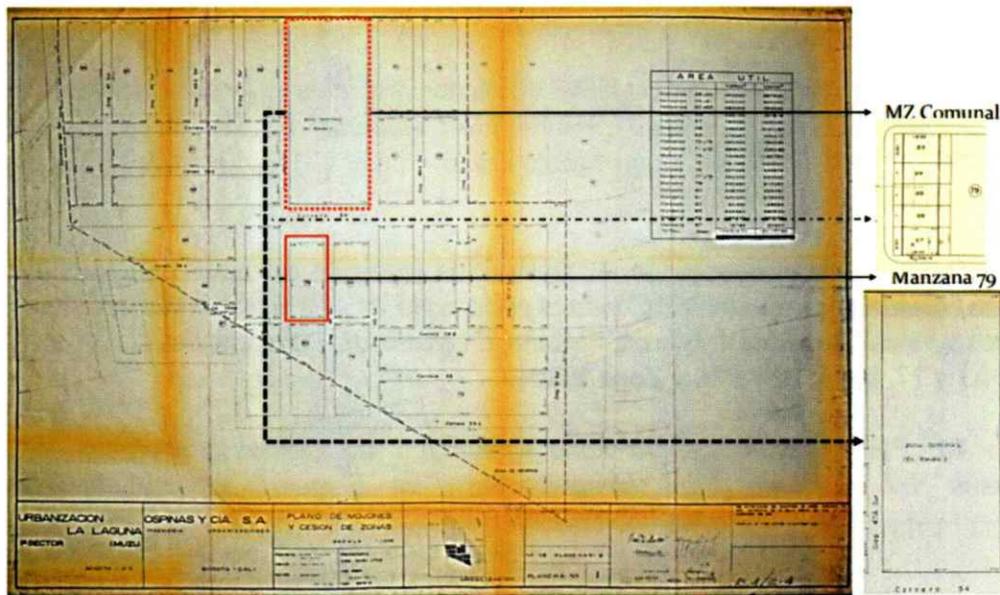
Plano de loteo de la Zona Comunal y de Comercio, Decreto 468 de 1960. Plancha 1/1 - Plano B4/4 Urbanización “La Laguna” (Muzú) 1º Sector.
